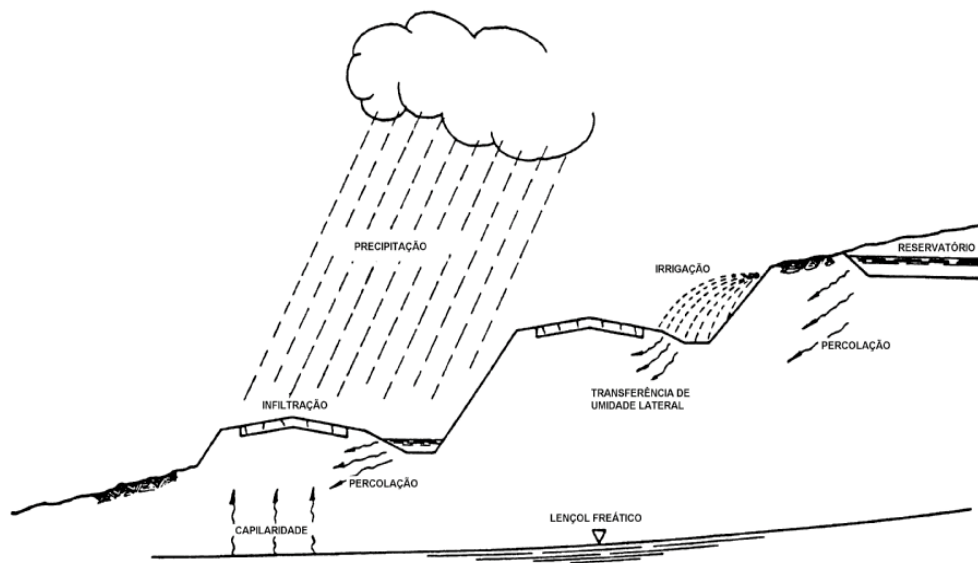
Origens da água que entram na estrutura do pavimento rodoviário, Ridgeway (1982)
